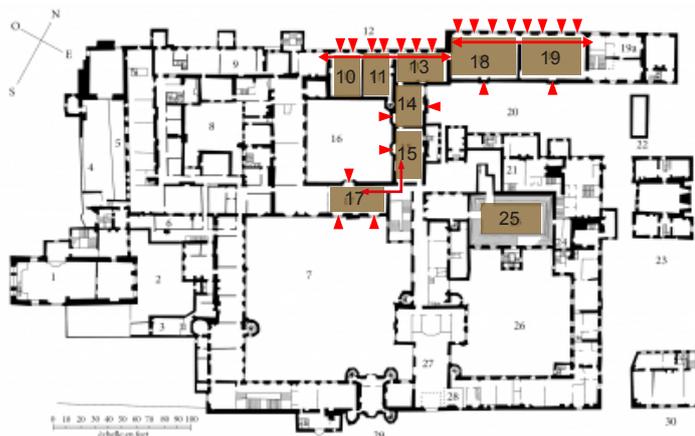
Figura A. Plano de planta de los apartamentos oficiales del palacio de Saint-James, primera planta (mediados del siglo XVIII). Inglaterra
